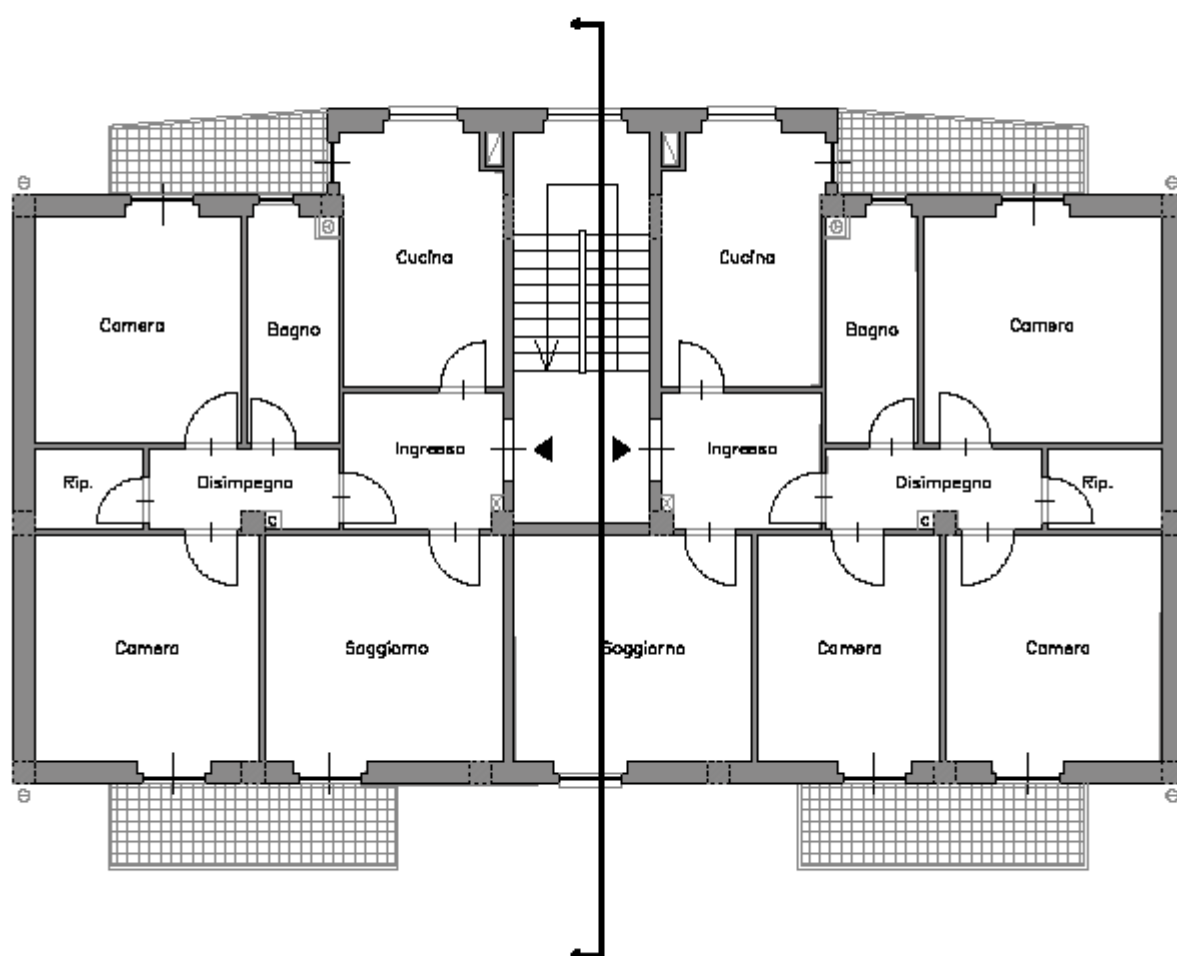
Architettonico – pianta piani primo secondo e terzo.
